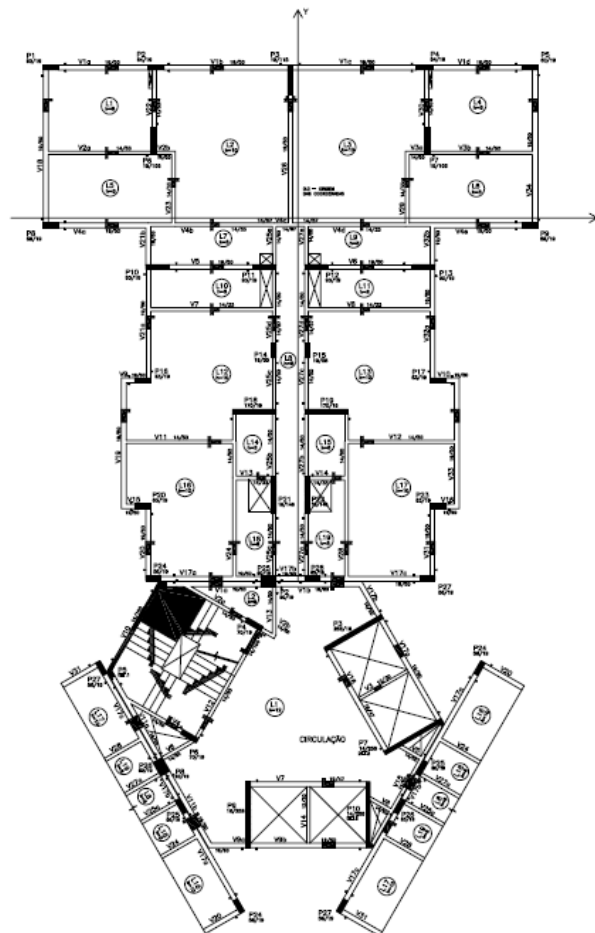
planta baixa do pavimento tipo da obra adotada como referência no comparativo
